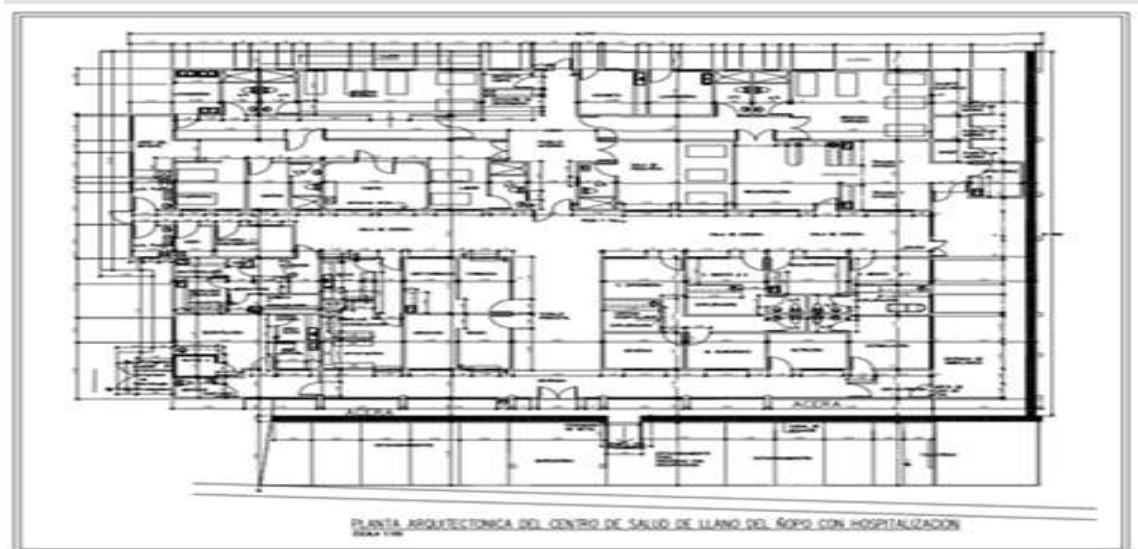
Planta arquitectónica del Centro de Salud de Llano Ñopo
